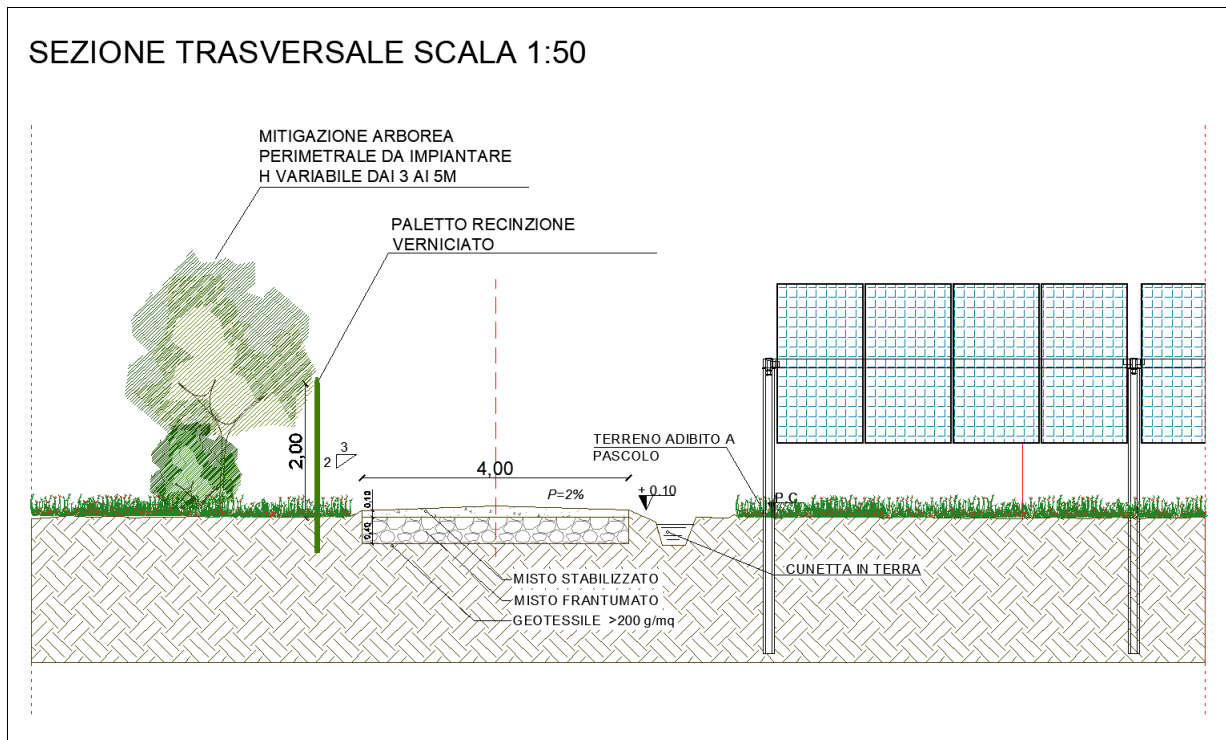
Dettaglio recinzione e mitigazione perimetrale
